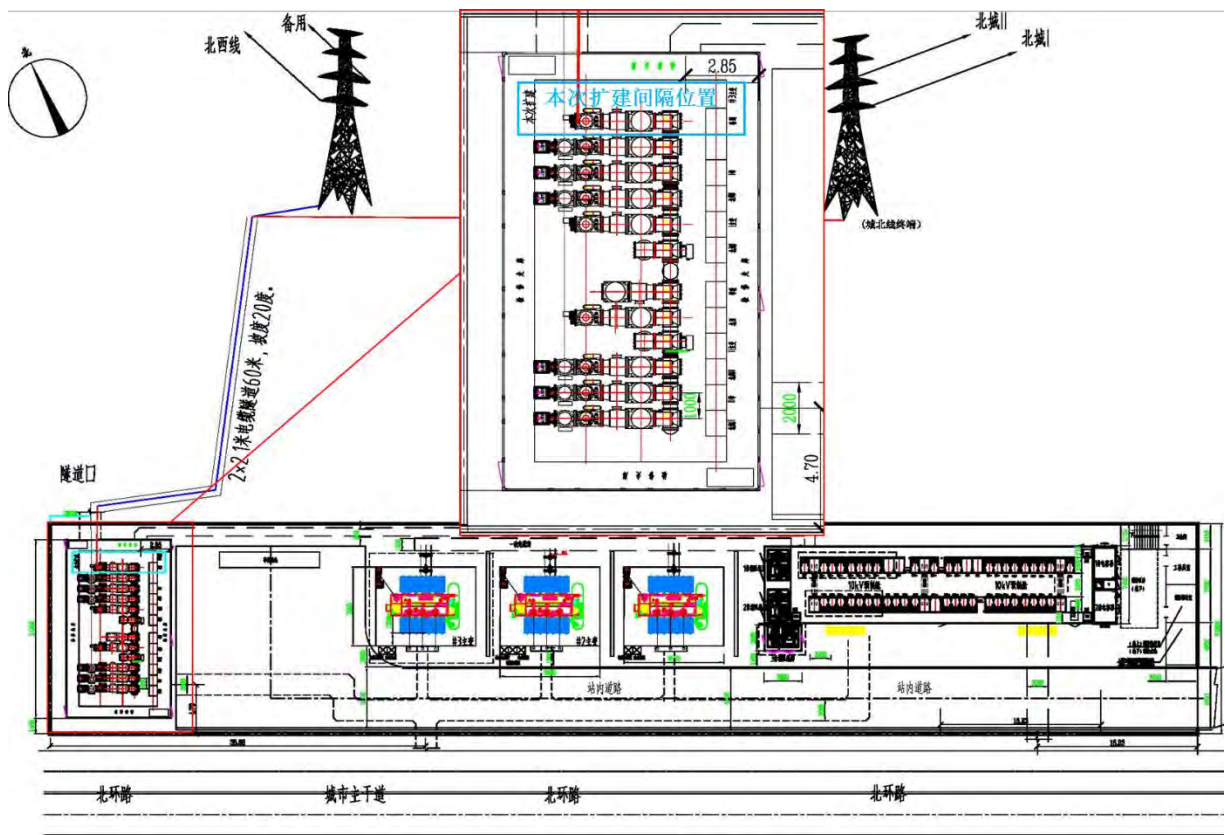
本次扩建间隔及北郊110kV变电站平面布置图
